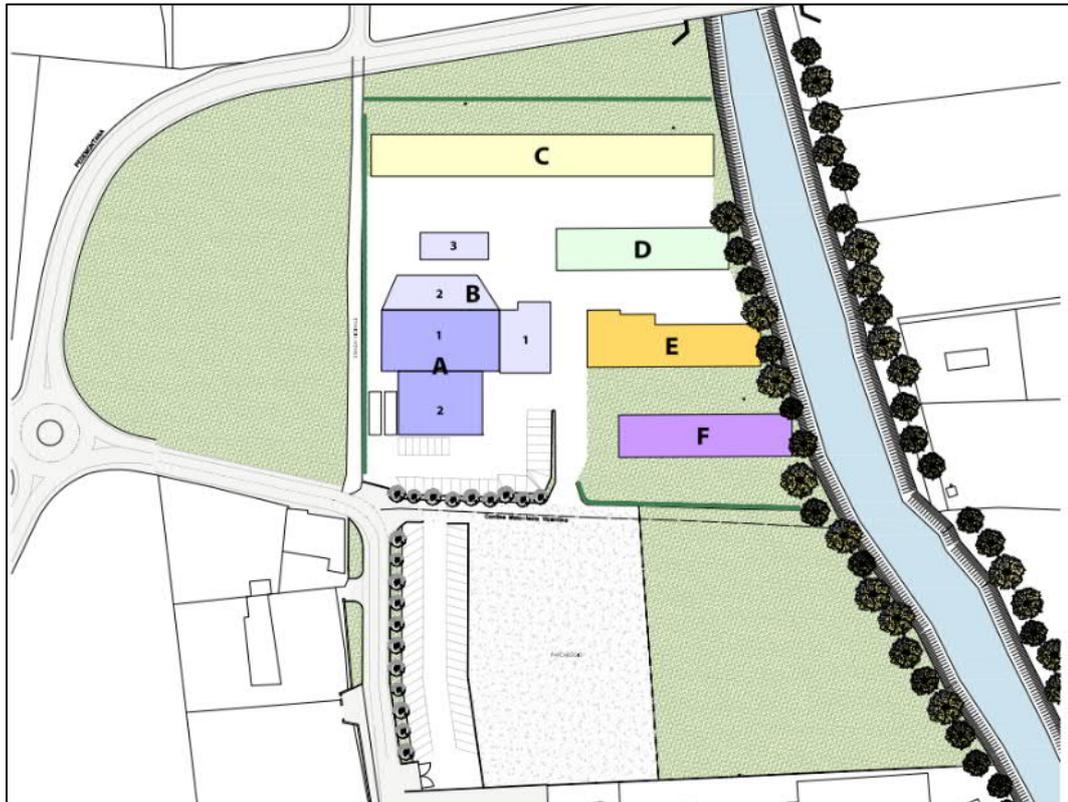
PLANIMETRIA DELLO STATO DI FATTO
